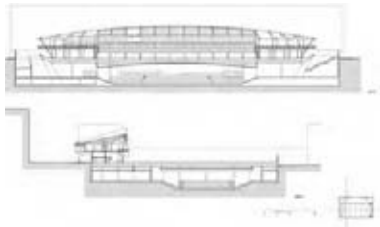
BURGIO G., *Progetto di restauro, spaccato prospettico
